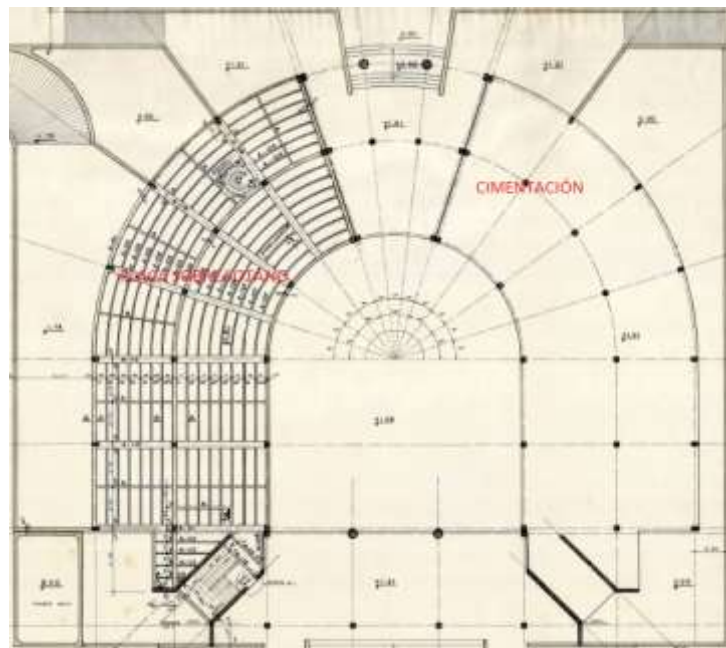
Fuente: autores, mayo 8 2018, Diseño de planta primer piso, Alcaldía de Yopal, planos originales por Ing. Carlos Navas Camargo, planta primer piso y placa de segundo piso.
